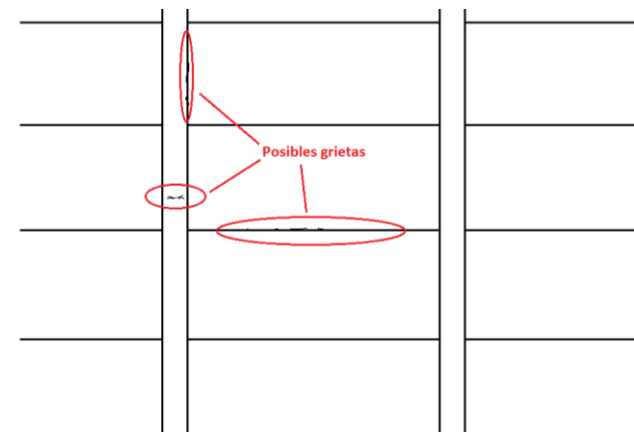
Patrón de grietas en sistema prefabricado de baldosas horizontales
